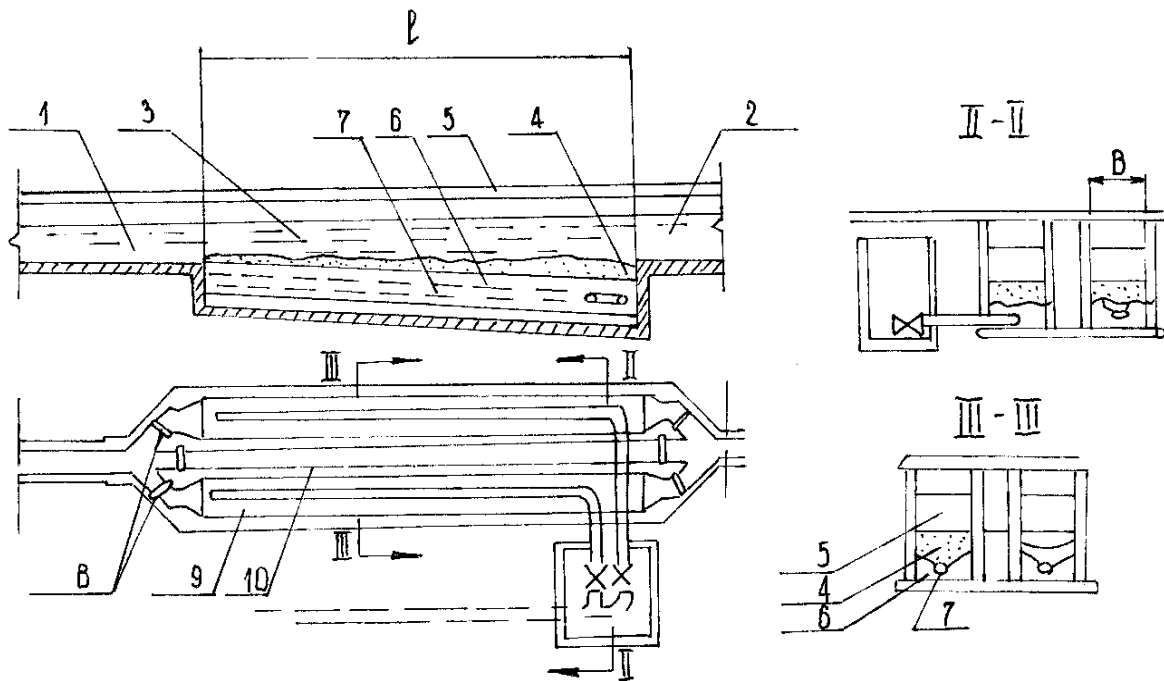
Горизонтальная песколовка: 1 – подводящий канал; 2 – отводящий канал; 3 – слой воды; 4 – слой песка; 5 – перекрытие; 6 – слой гравия; 7 – дренажные трубы; 8 – шиберы; 9 – секция; 10 – аварийный канал
